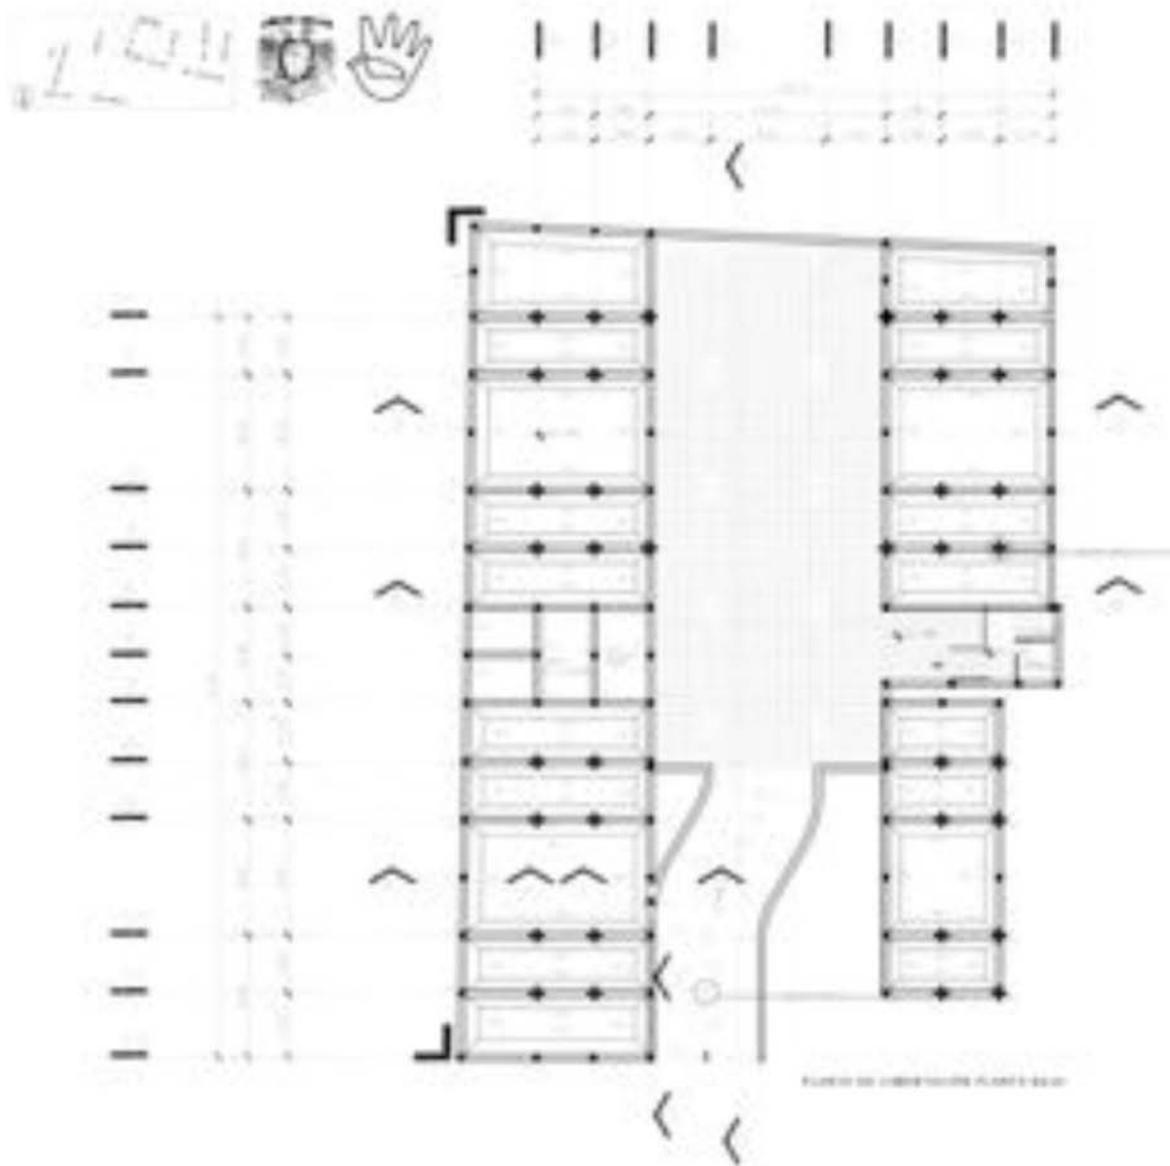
Planta de cimentación. Solución a base de zapatas continuas de colindancia que continúan en los muros de contención del sótano.
